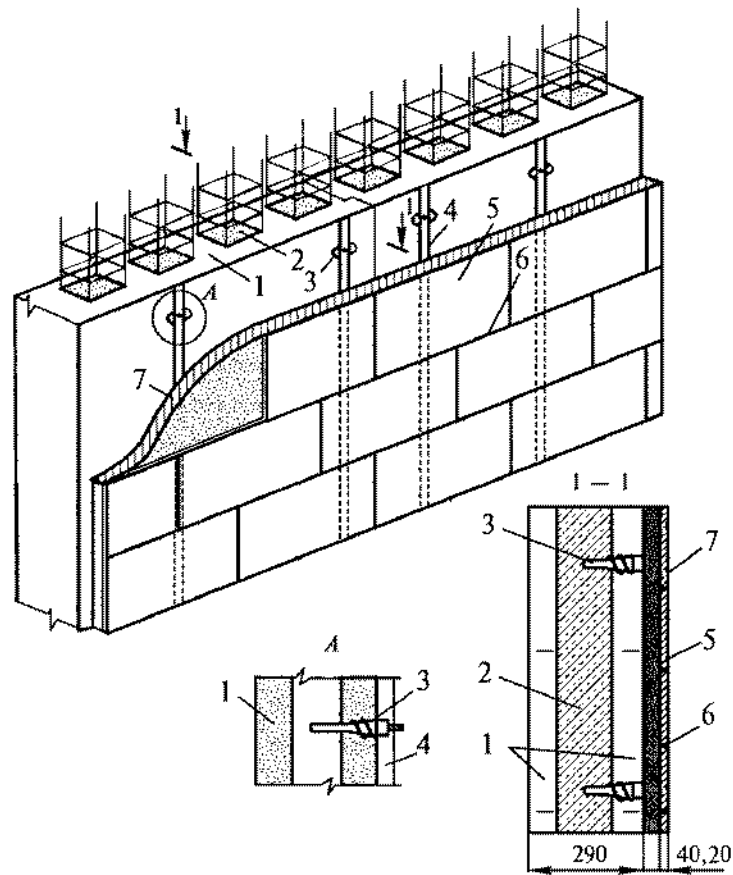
Схема облицовки стен, возводимых в несъемной опалубке:
